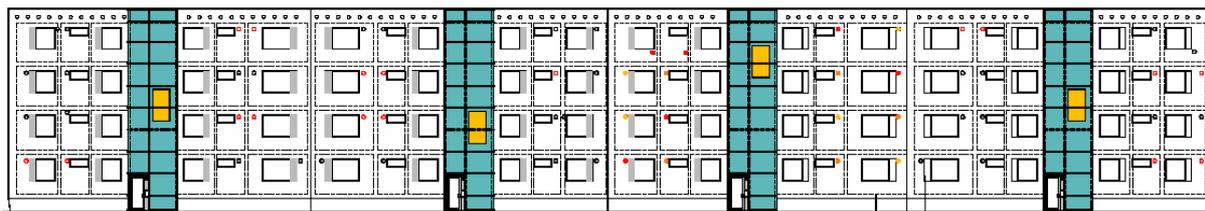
Planung Sanierung Ansicht Nord mit Liftzubau
